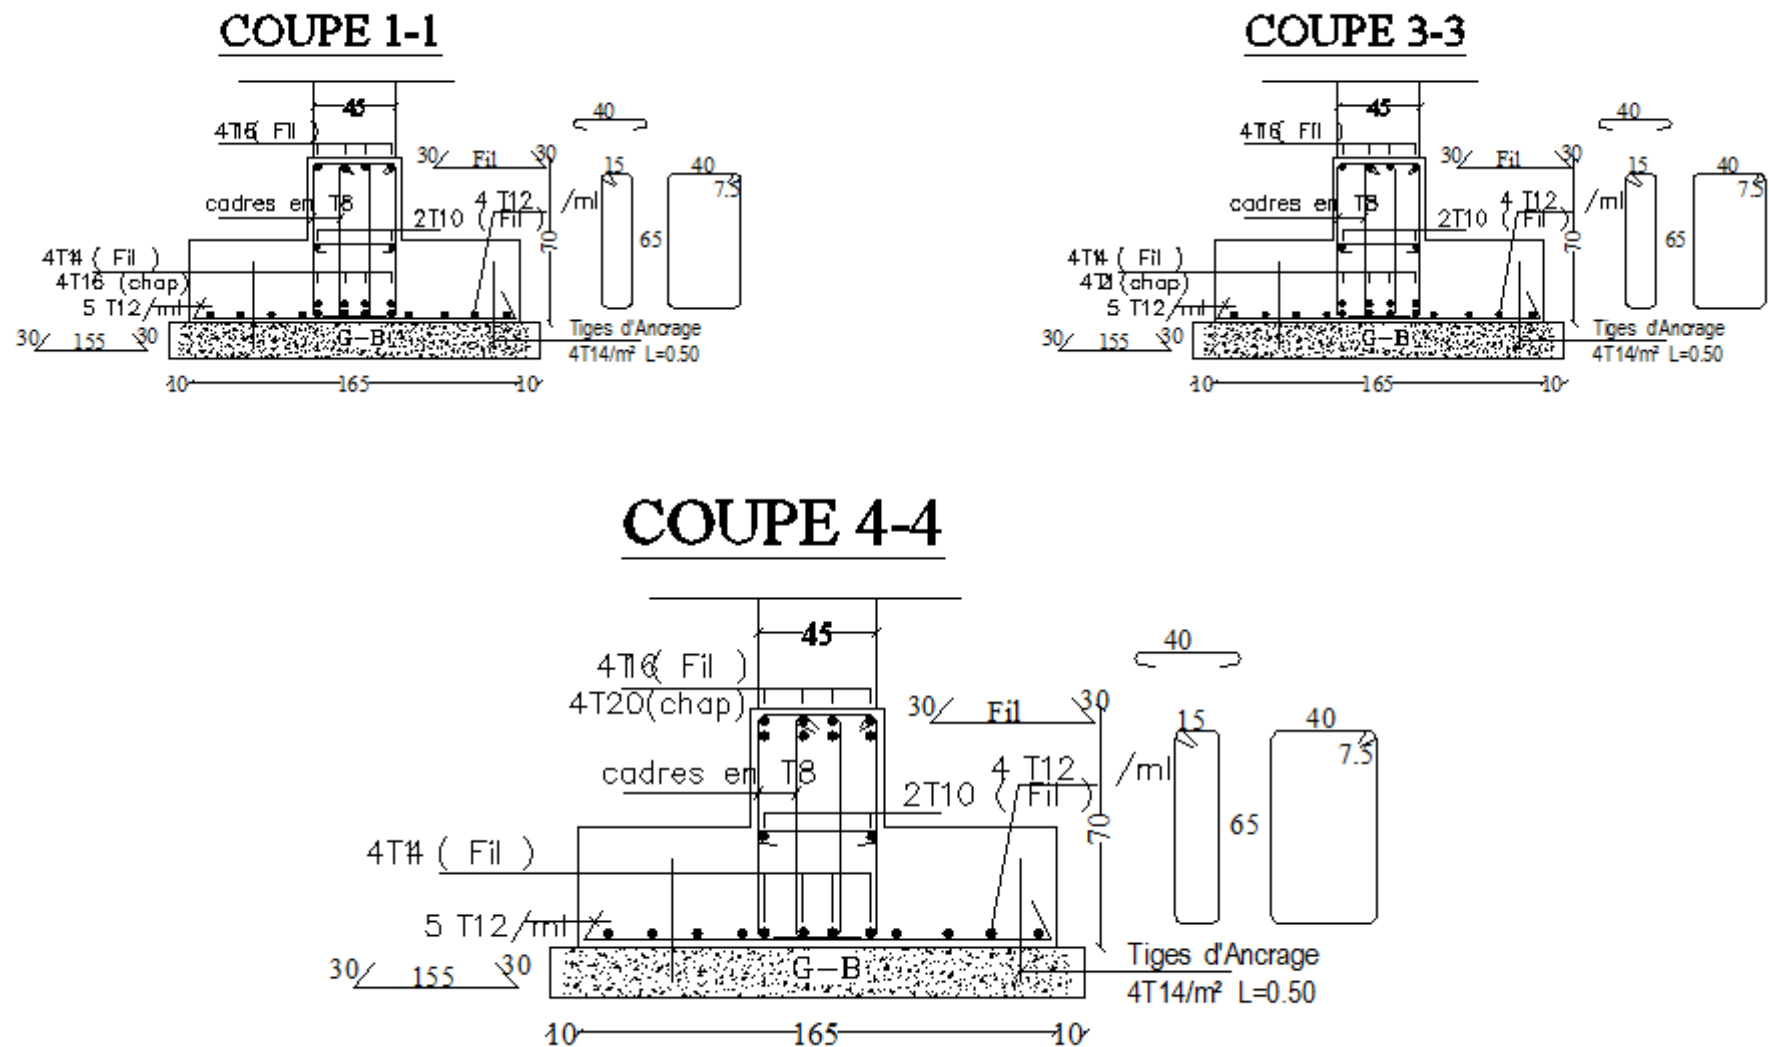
Plan de ferrailage de la semelle sous poteaux
